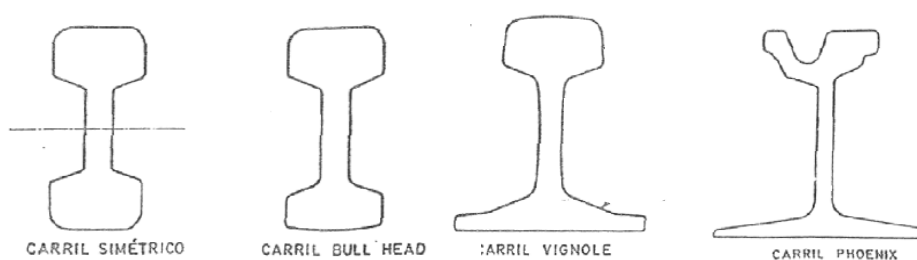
Tipos de Carril [adaptado de Fontul, 2008]
